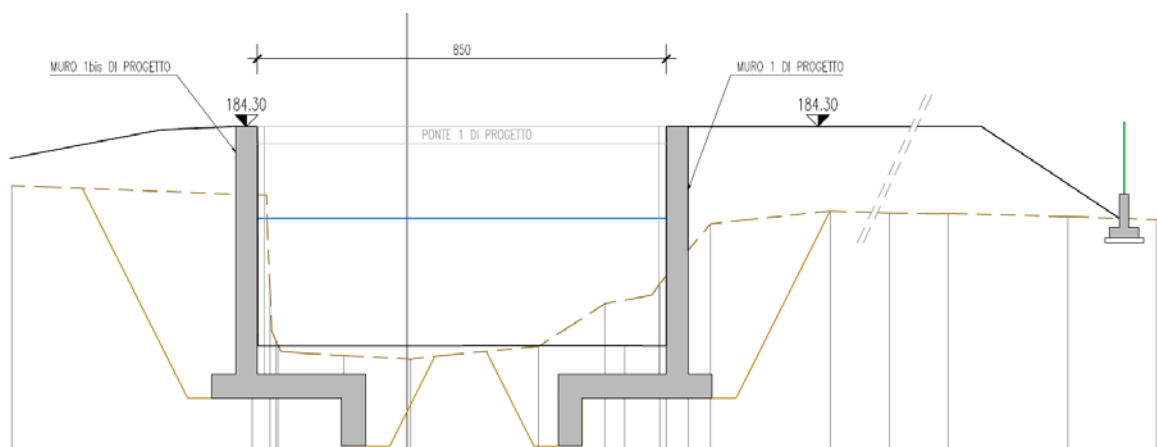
Estratto Tavola 07 – sezione del ponte 1 privato
